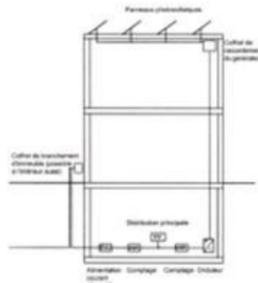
Principe d'une installation photovoltaïque reliée au réseau. (Ernst Neufert 10^e édition française, Les éléments des projets de construction, pp 518)
